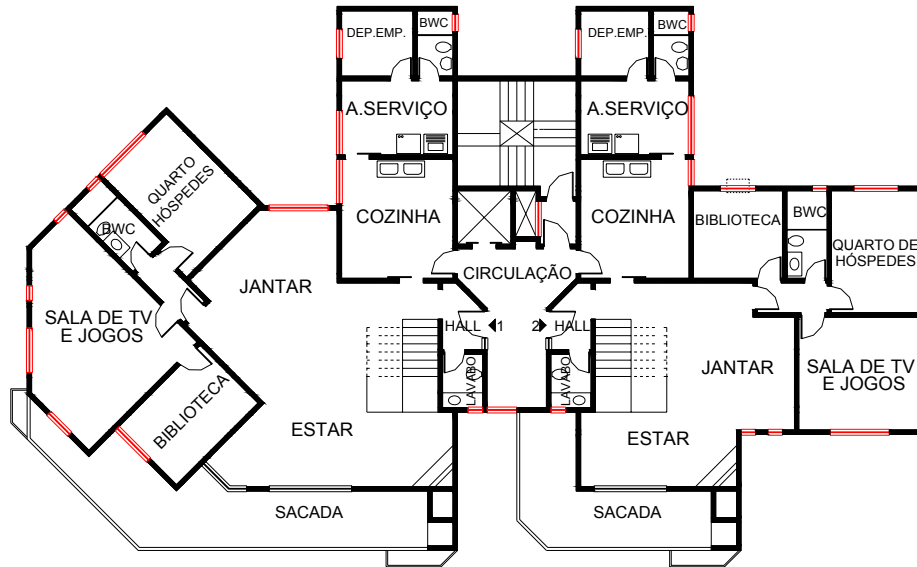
Planta Baixa do 8º pavimento do Estudo de caso C (Apartamento Triplex).
